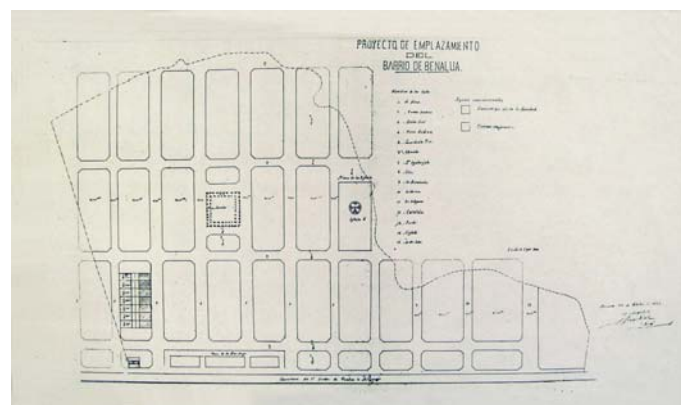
Proyecto de Emplazamiento del Barrio de Benalúa*, firmado por el arquitecto José Guardiola Picó con fecha 20 de octubre de 1883. Copia que se encuentra en el Archivo Histórico Municipal de Alicante. Plano original desaparecido.
